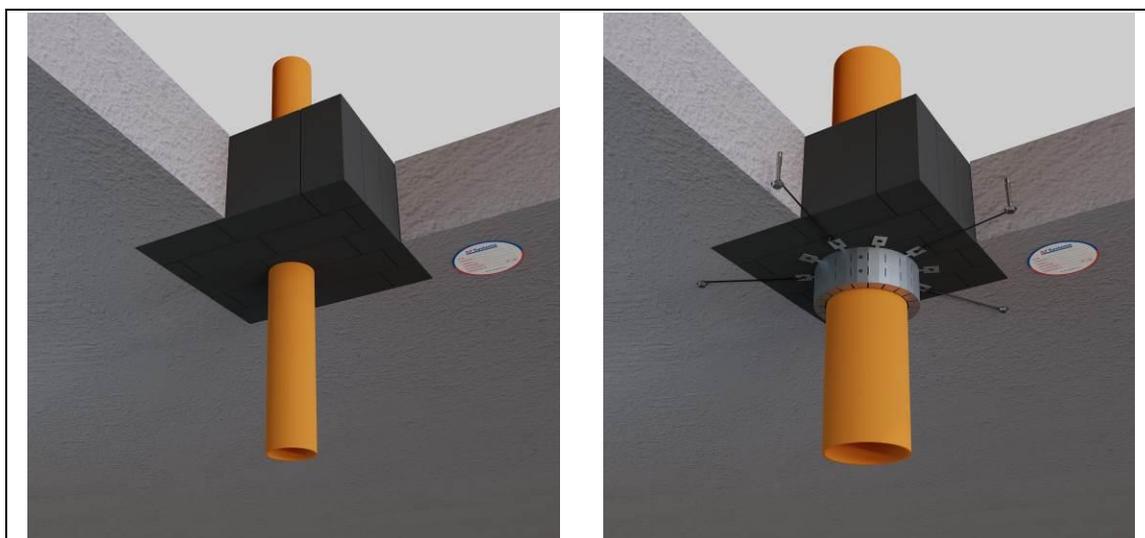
Exemples de calfeutremments de pénétration avec AF BRICK pour les tuyaux en plastique dans les planchers.
